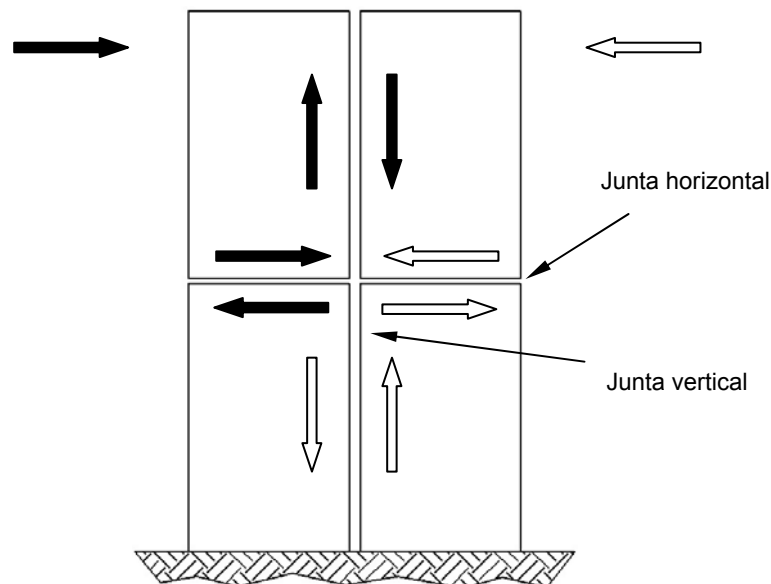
Transmissão de forças de corte entre painéis de parede
